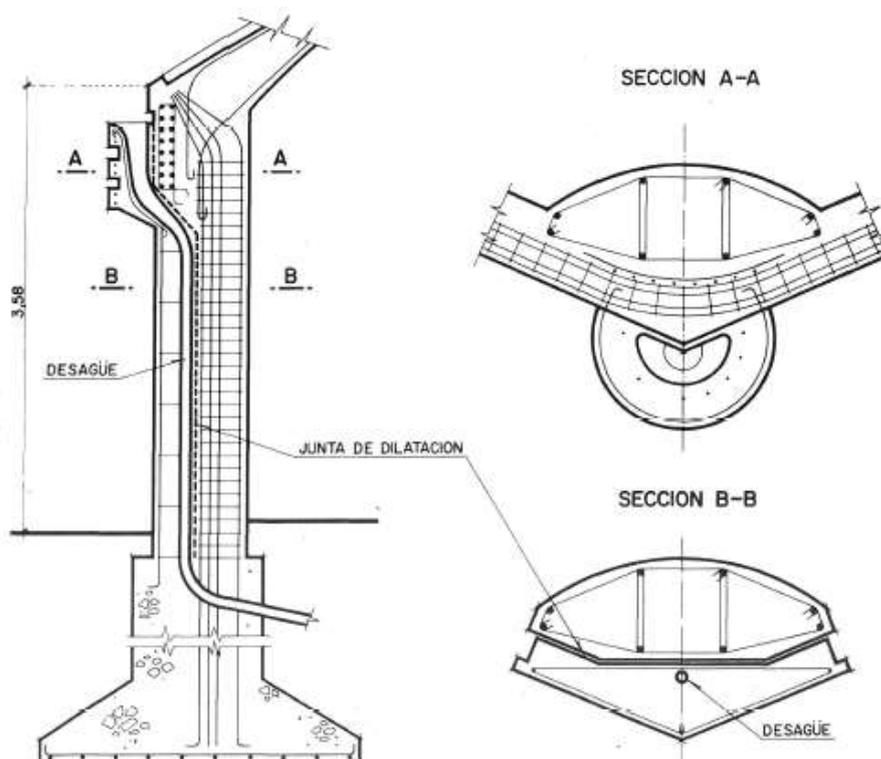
Detalle constructivo de los pilares del Mercado de Algieras
